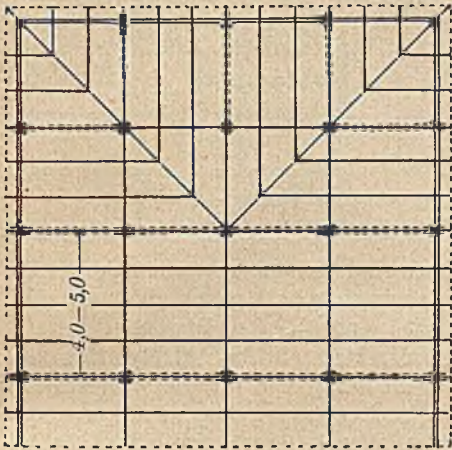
Pfettenwalmdach mit dreifach stehendem Stuhl.
